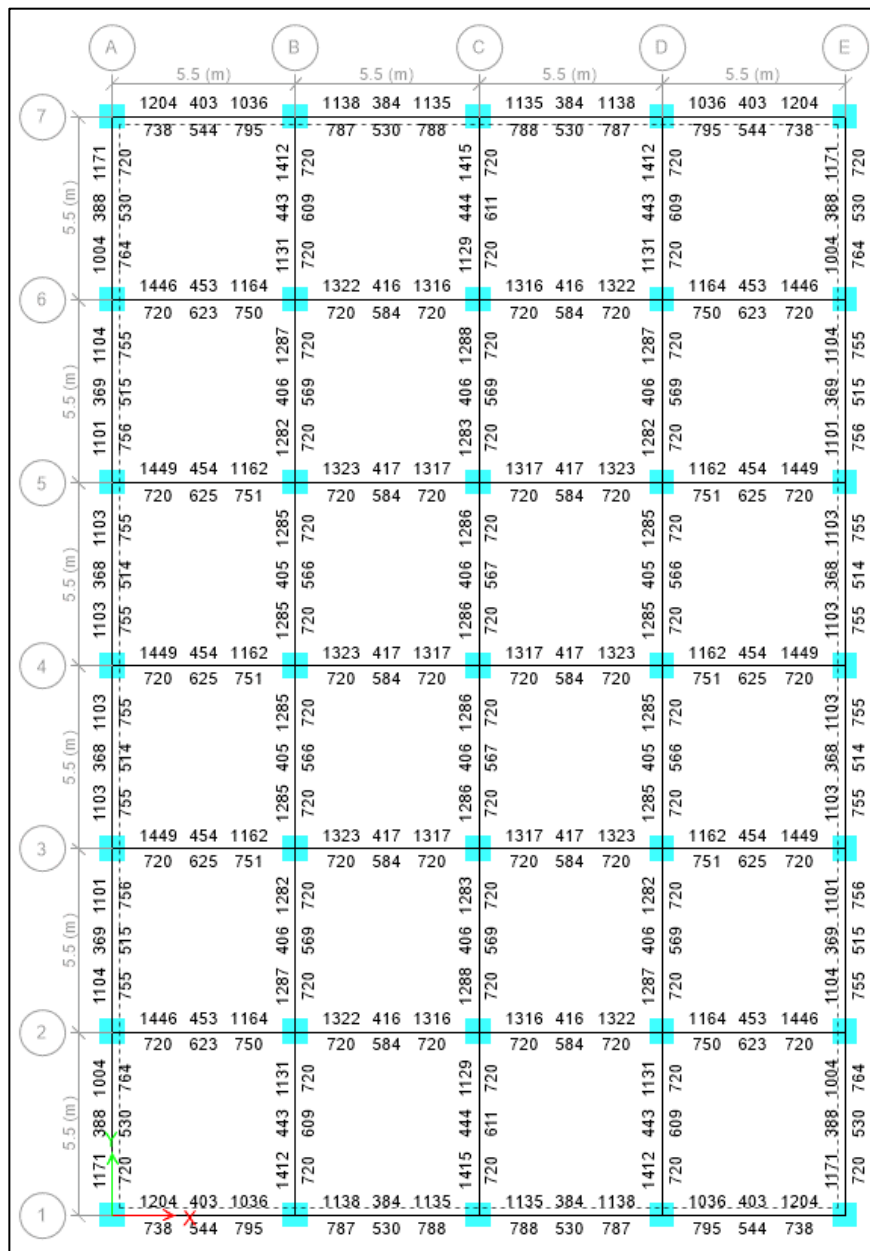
Aceros de refuerzo grado 60 (mm²) en vigas del nivel 3 (planta)
